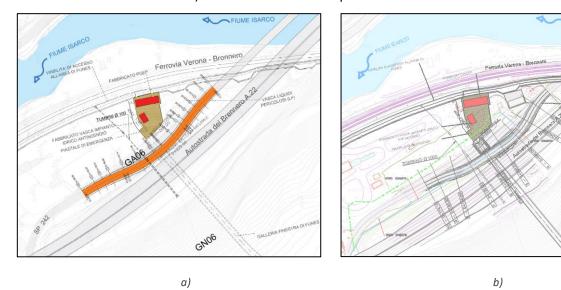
Planimetria d'intervento della deviazione della S.P. 27 a) Soluzione PD; b) Soluzione PE
